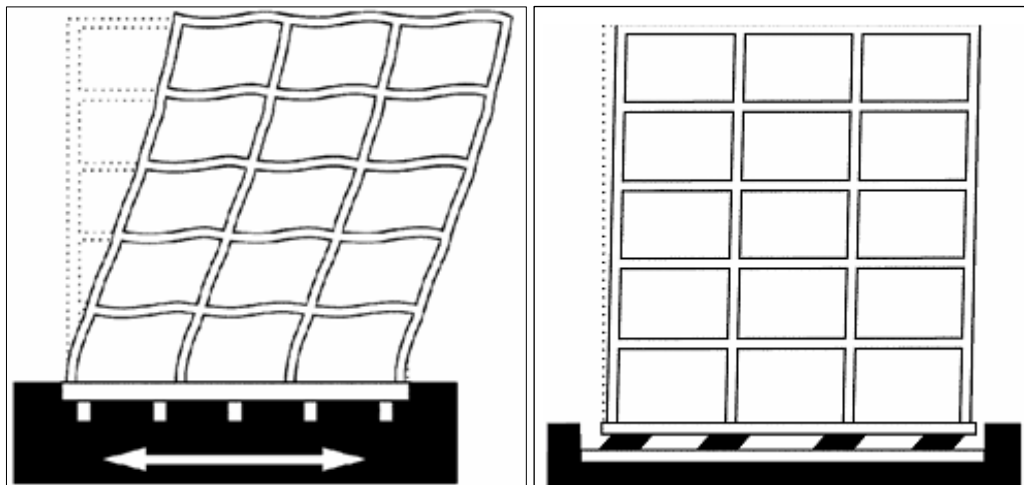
a) edificación sin aislador de base. b) edificación con aislador de base.
